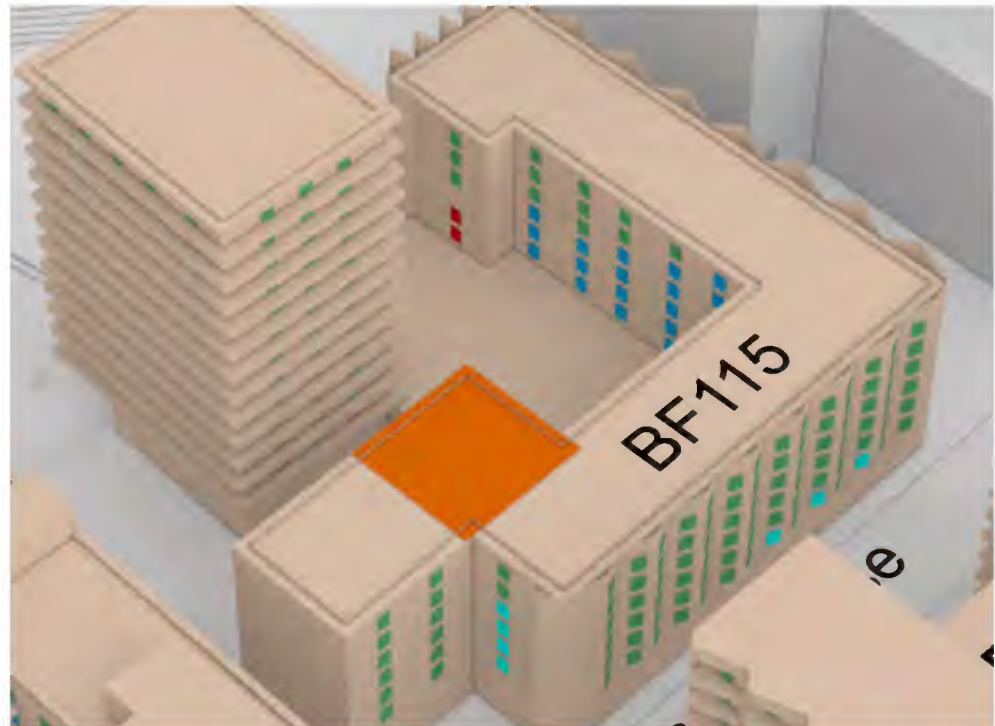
Baufeld 115- Südfassade und Westfassade - Maßnahmenempfehlungen
